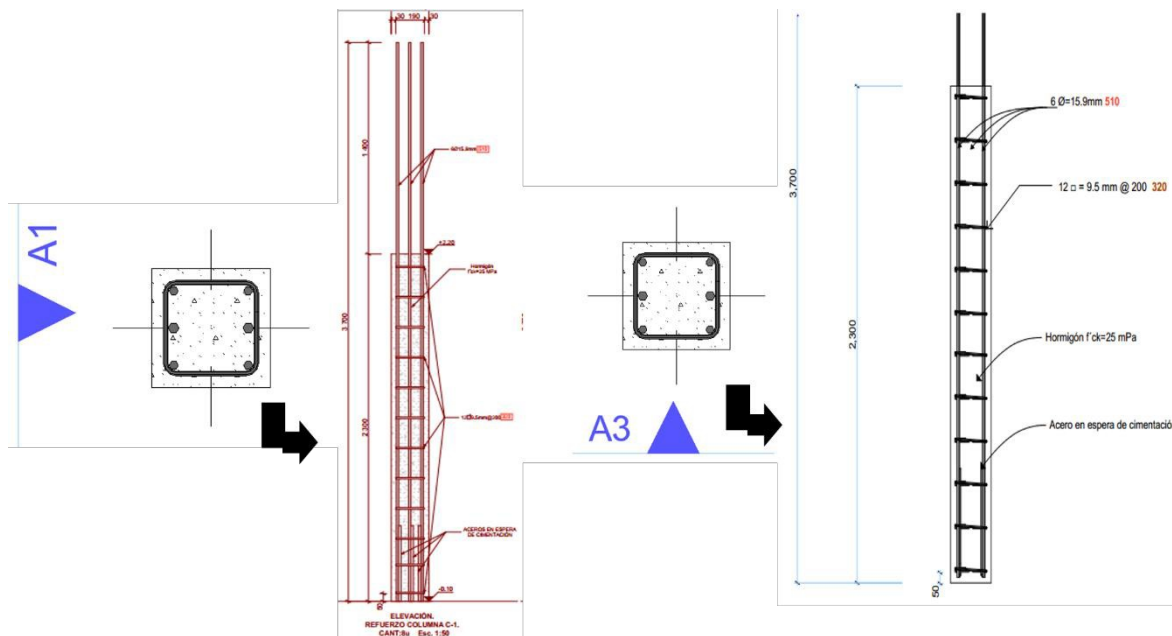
Elevación Frontal (A-1) y Lateral (A-3) de la columna C-1 utilizando la información paramétrica del modelo.
